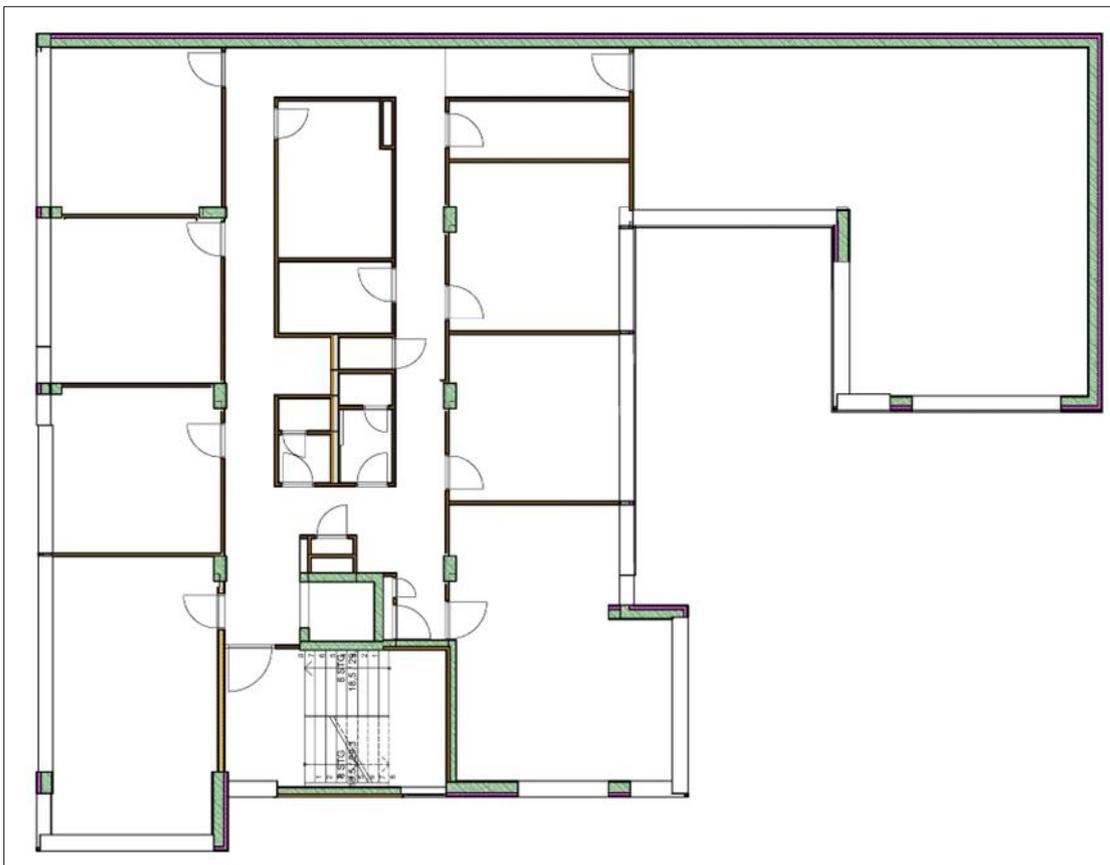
Fallbeispiel Grundriss OG2
